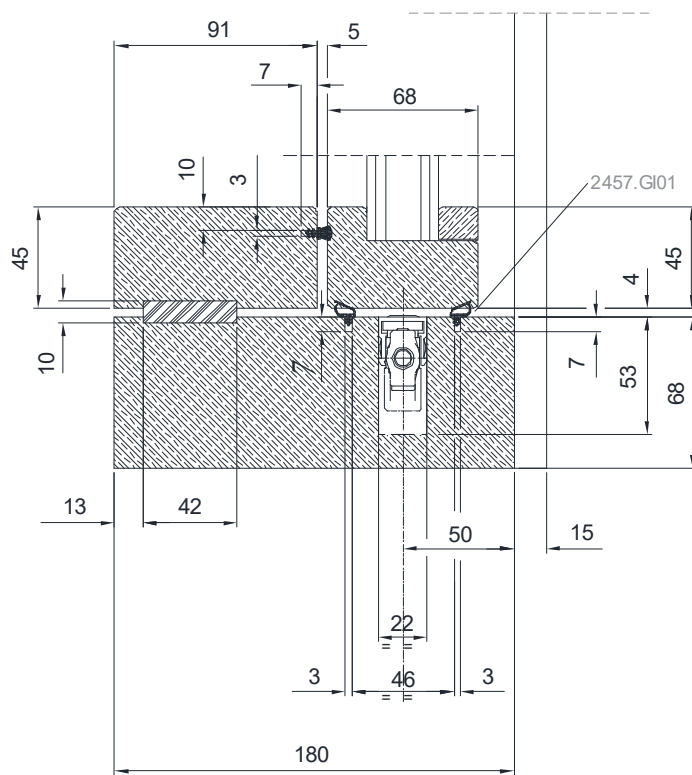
Section du nœud latérale - vantaël ouvrante- serrure 27 mm (dimensions nominales déclarées, exprimées en mm)
